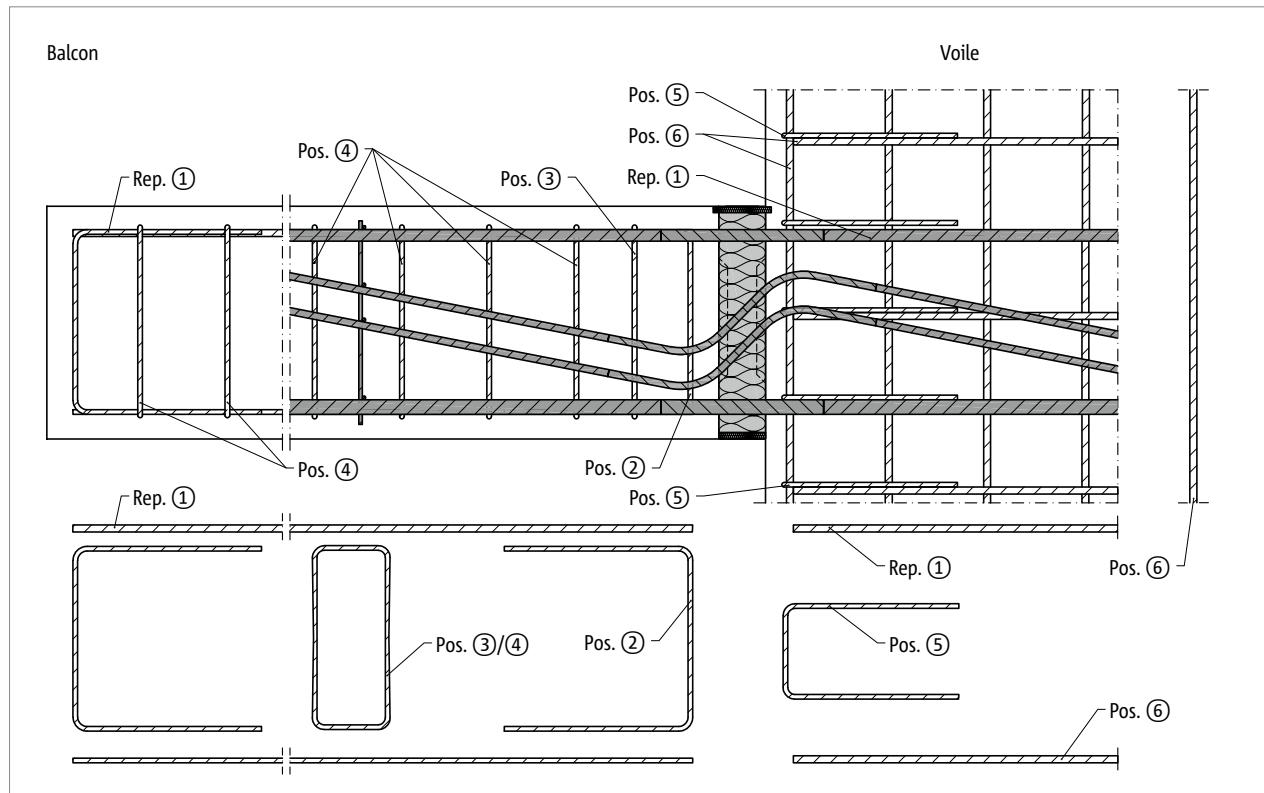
Schöck Isokorb® T Type B : Renforcement sur site (coupe)
